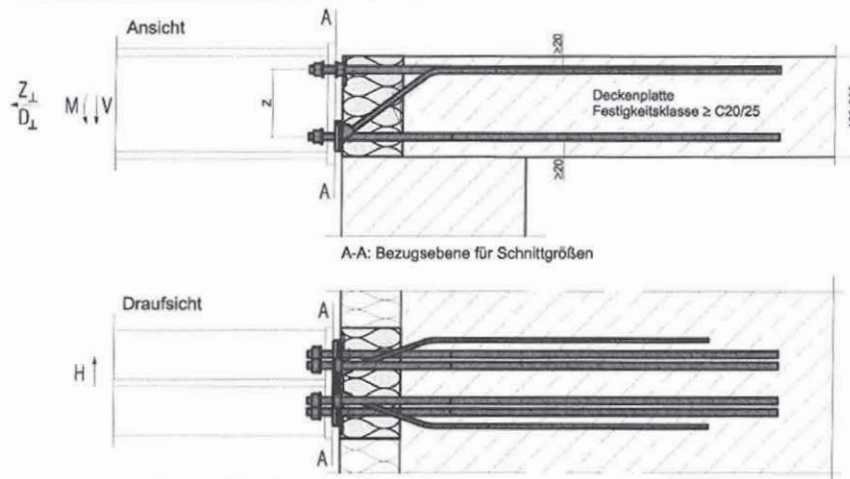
und 70: Schöck Isokorb® Typ KSXT14 VV, Schnittgrößendefinition
